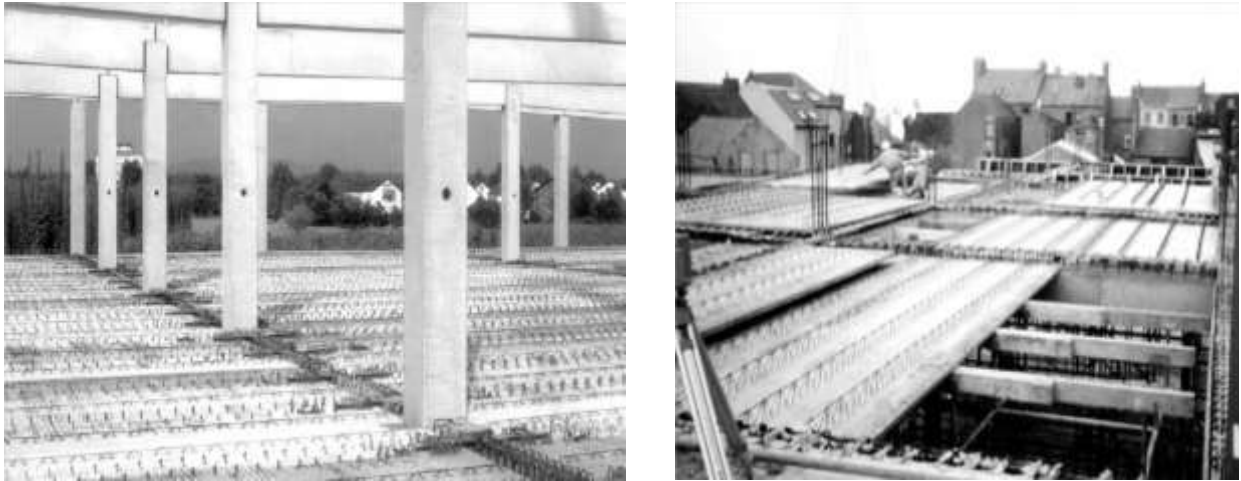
Losa solida con refuerzo que sobresale para posteriormente hacer un colado in situ.
